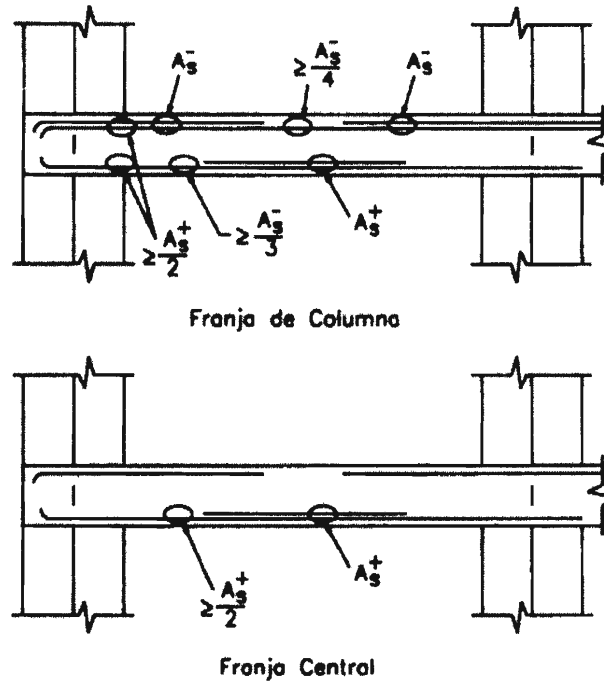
Requerimientos mínimos para el refuerzo longitudinal en losas armadas en dos sentidos apoyadas directamente sobre columnas
